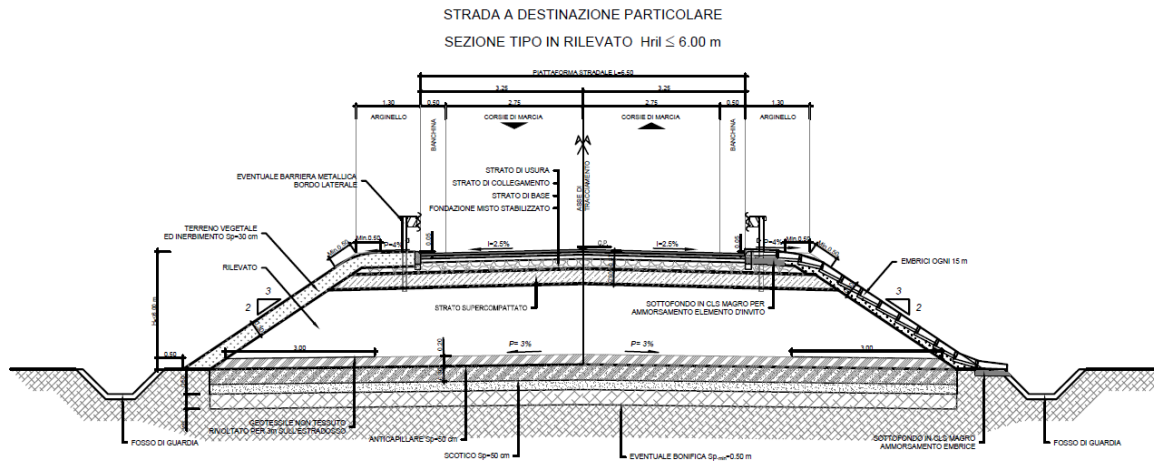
Sezione tipo rilevato – strada a destinazione particolare
